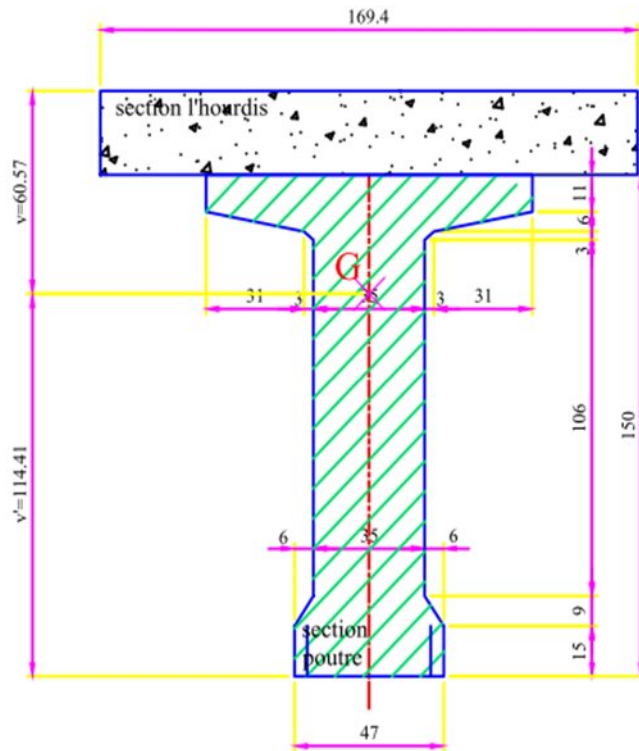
les dimensions de la section de la poutre+ l'hourdis à l'intermediaire
